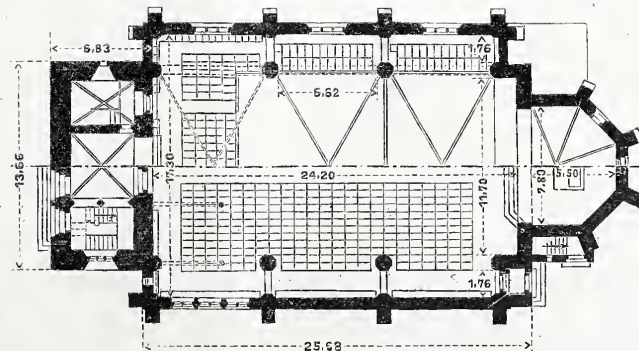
Grundriß zu ebener Erde und über der Empore.
